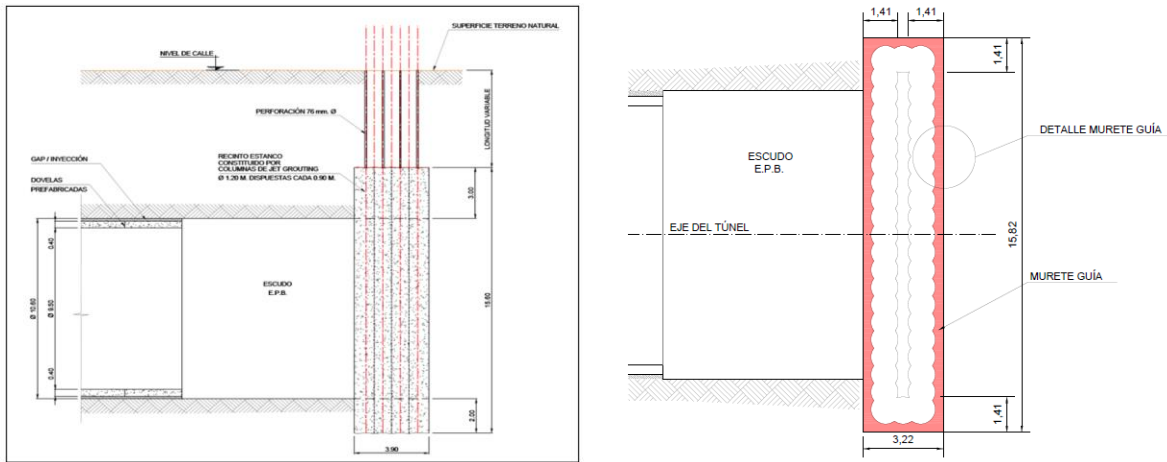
Punto de Revisión tipo (perfil y planta). Fuente: SENERMEX.
